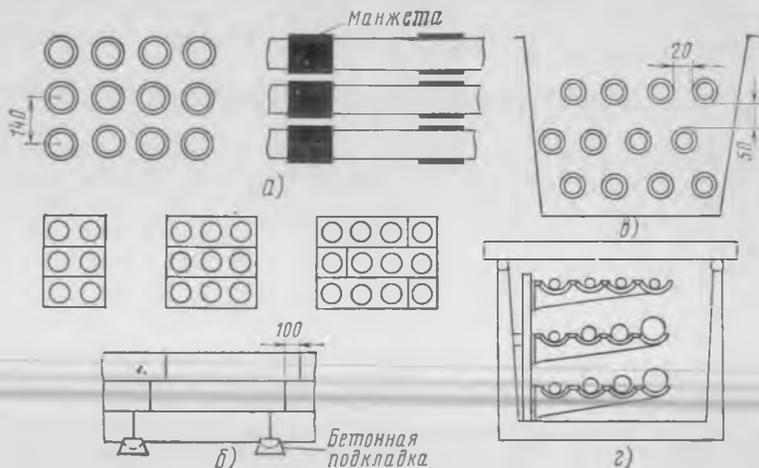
Расположение трубопроводов в блоке: а) асбестоцементные трубы; б) бетонные блоки; в) полиэтиленовые трубы; г) лотковая канализация
